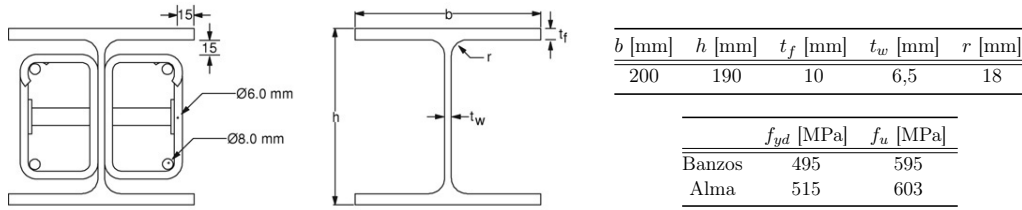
Viga C20Y0 (adaptado de Elghazouli e Treadway, 2008).
